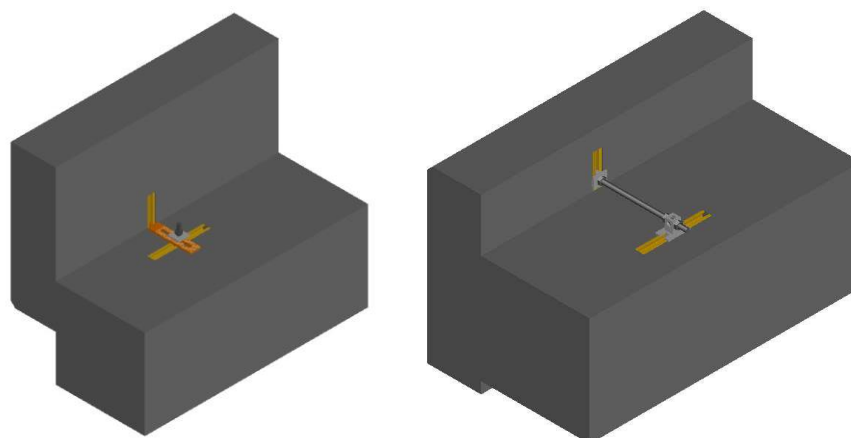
Pormenor de fixação de um painel pré-fabricado com uma viga pré-fabricada (José Rui Pinto,2021)
